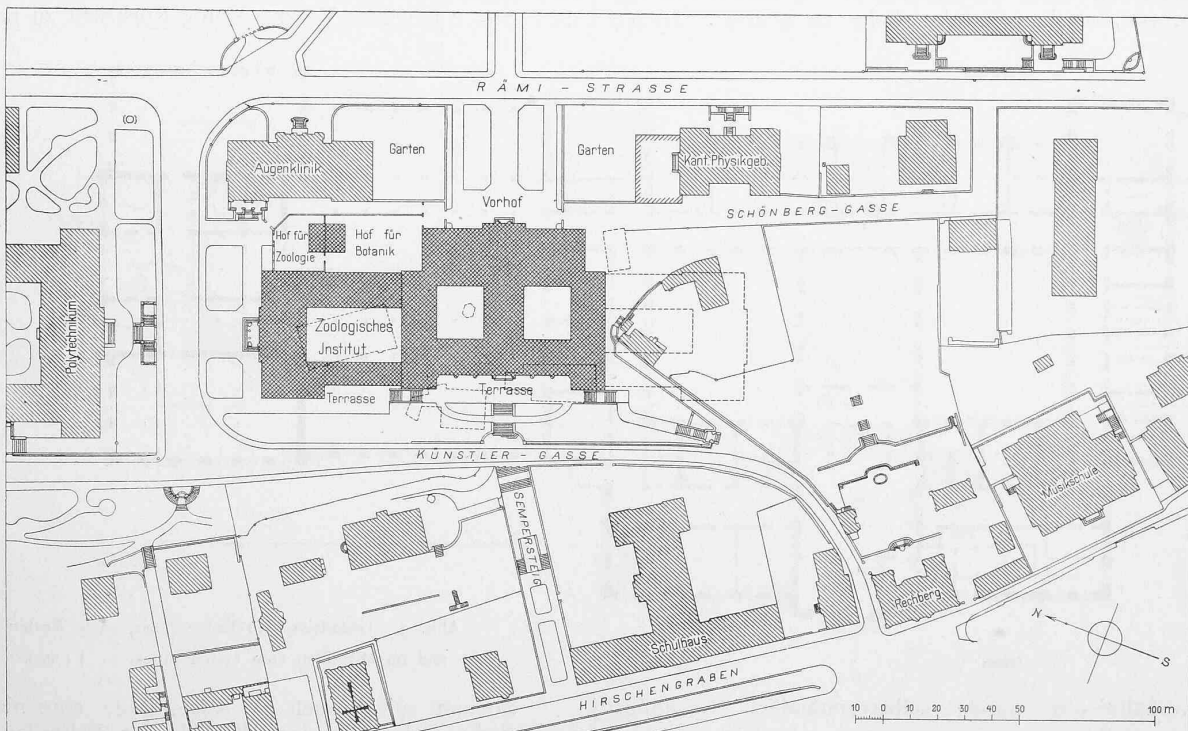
Lageplan der ganzen Anlage. — Masstab 1:2500.
